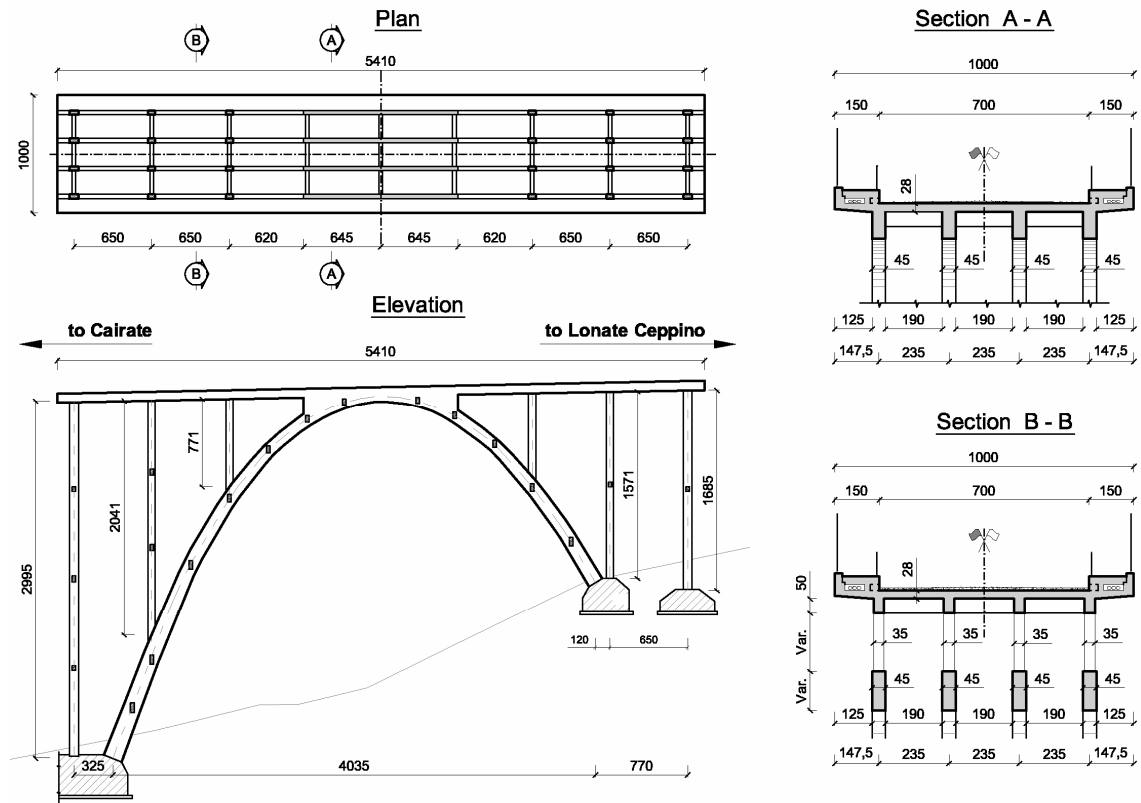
Vista longitudinale, pianta e sezioni tipiche dell'arcata analizzata
